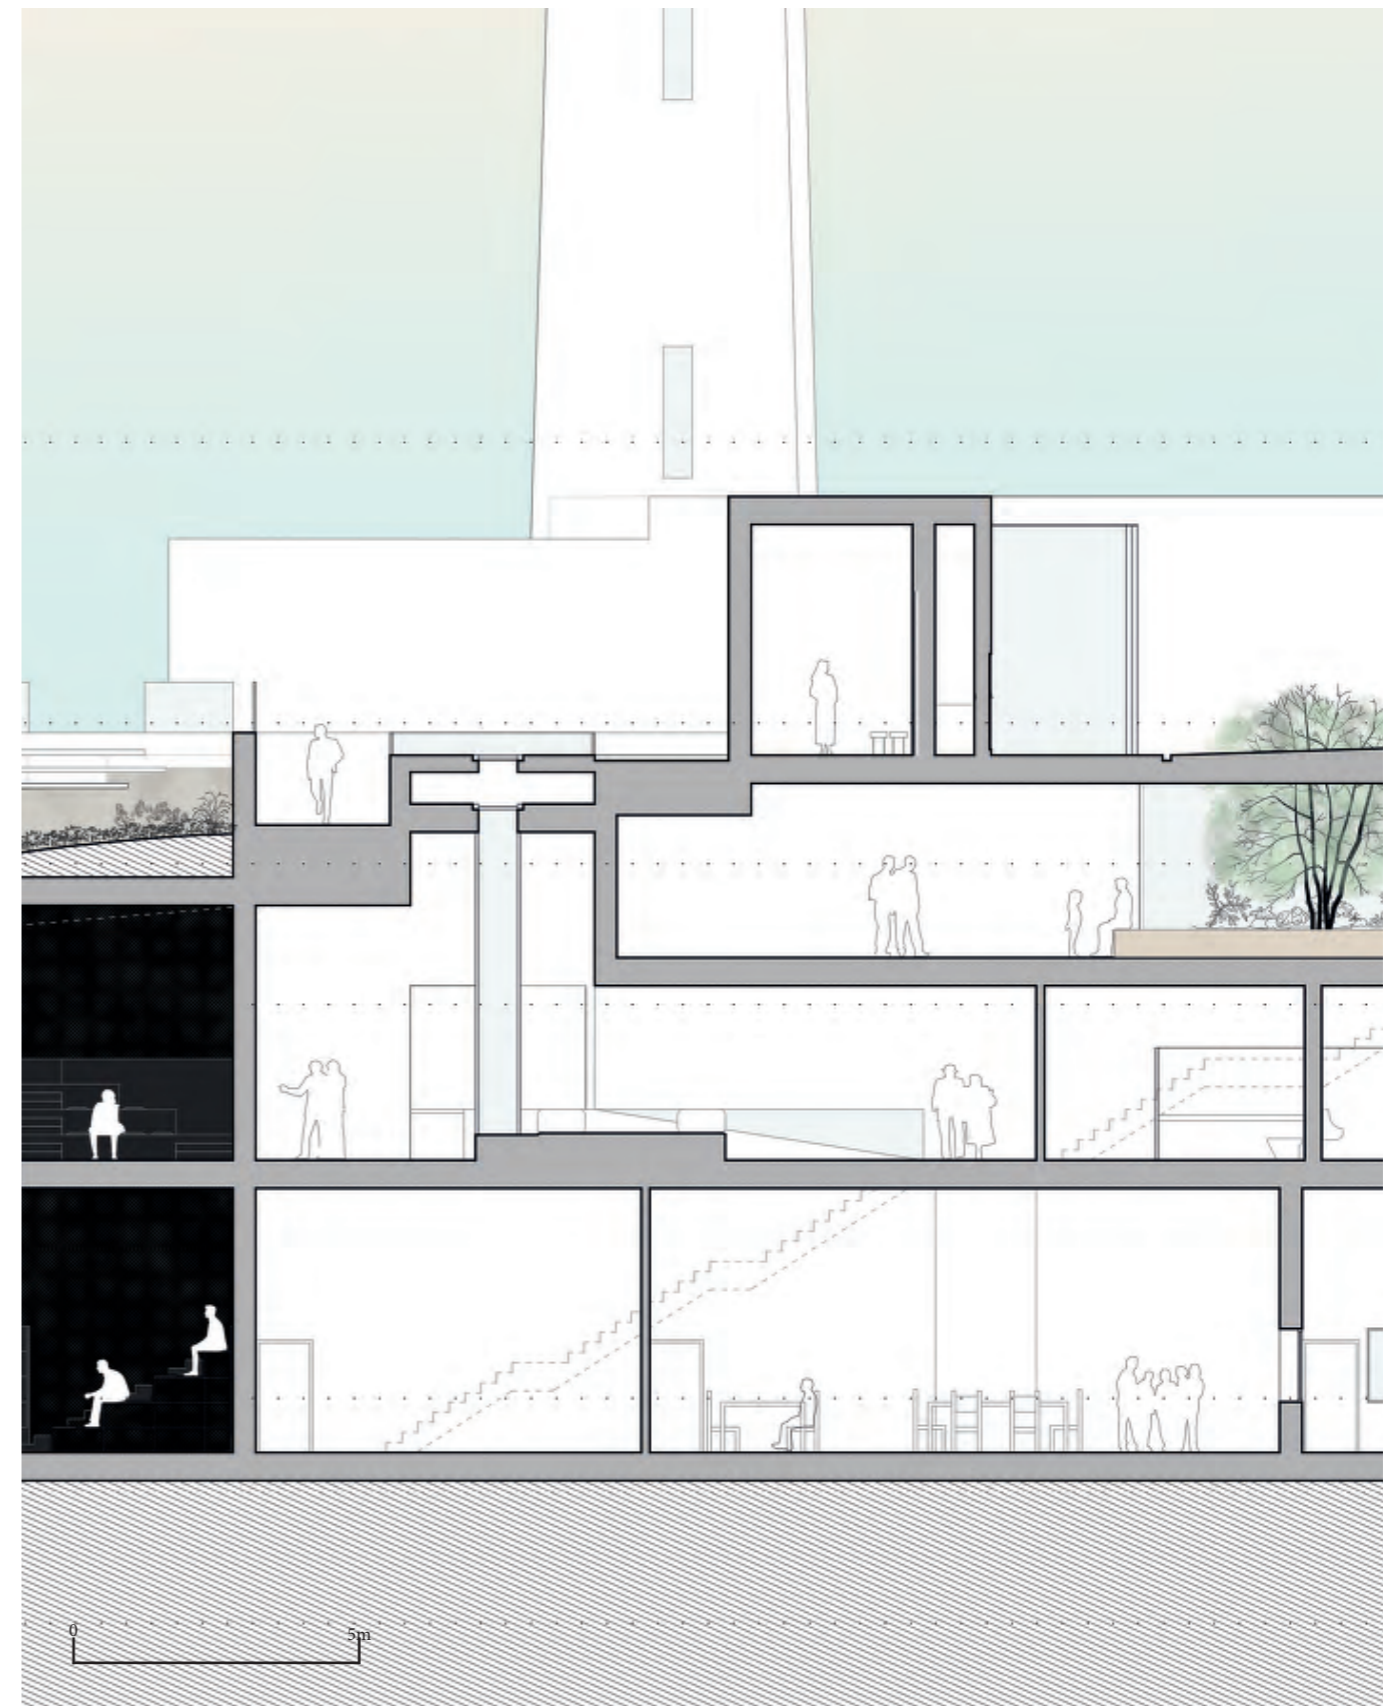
PROPOSTA - Corte longitudinal F- *Foyer* (legenda em anexo).
